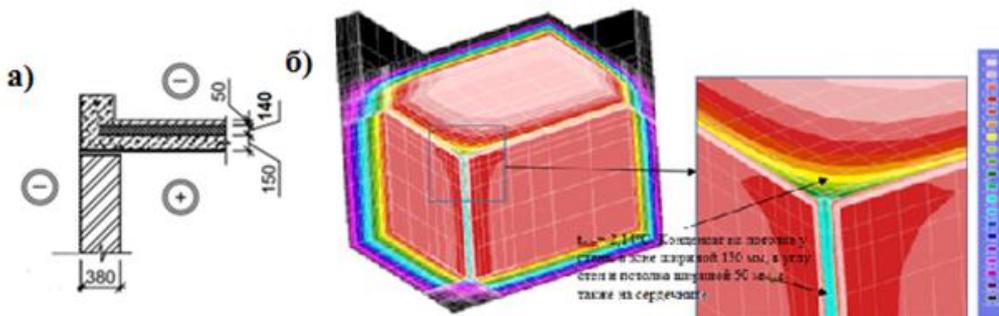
Узел примыкания наружной стены к чердачному перекрытию (исходный вариант): а – конструкция узла; б – температурное поле узла
